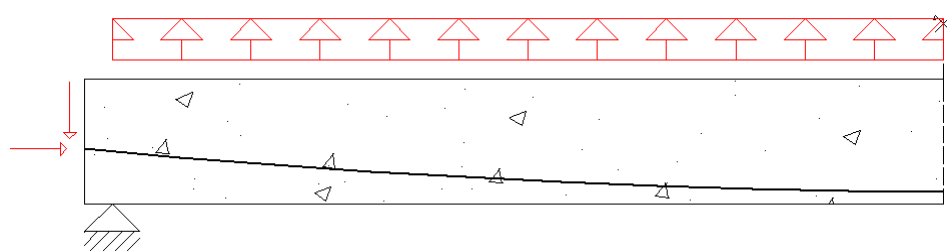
Vista lateral da viga de betão armado pré-esforçado com um tirante longitudinal parabólico e respetivas cargas equivalentes e forças pontuais.
